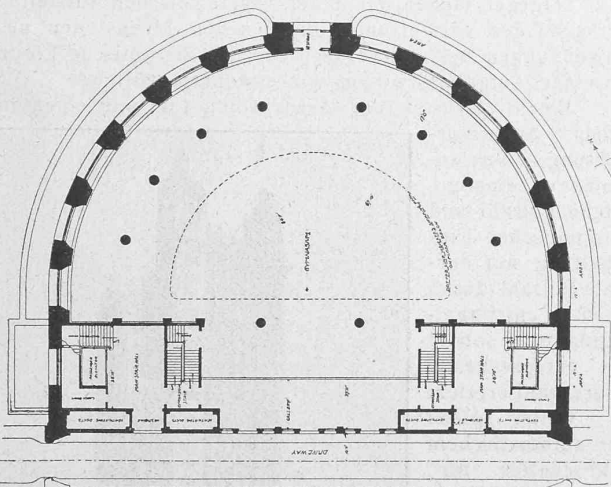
Columbia University. — Turnhalle. Grundriss vom Hauptgeschoss 1 : 700.
